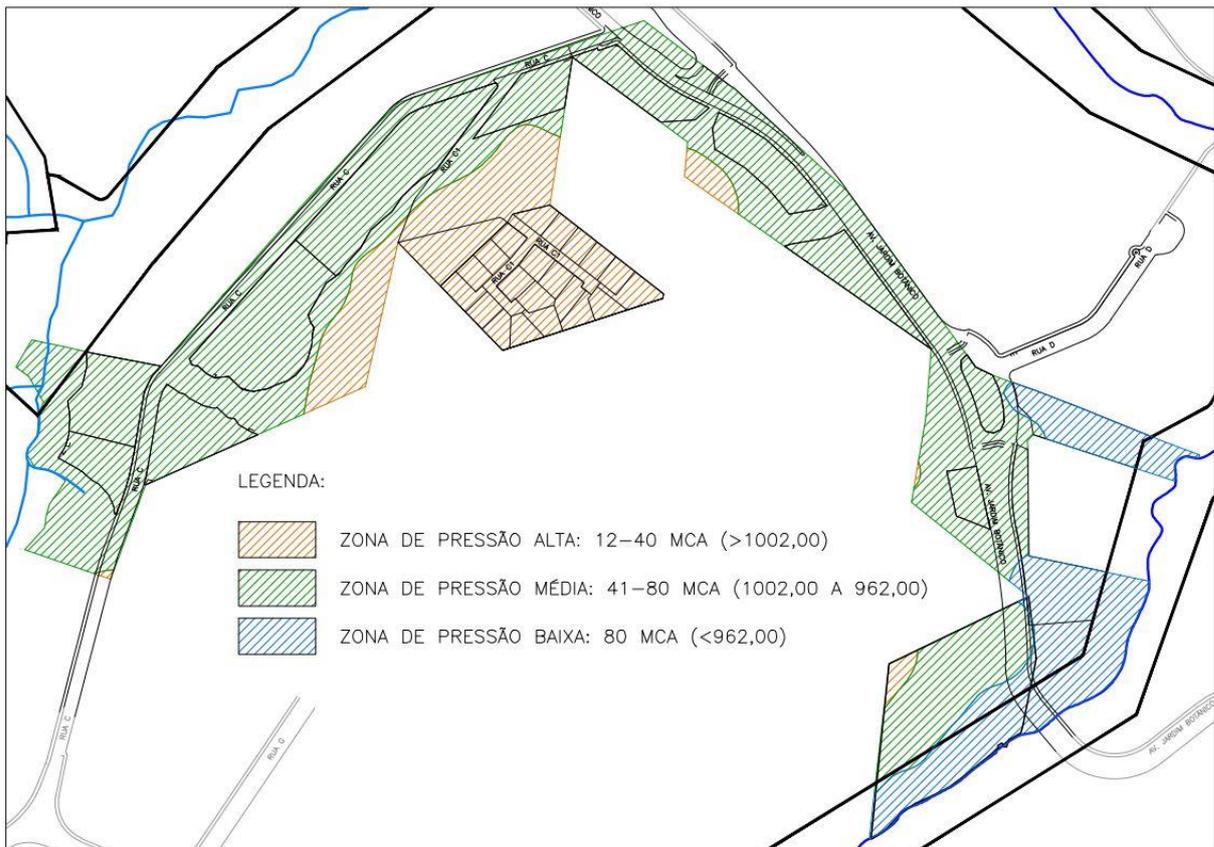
Zonas de pressão do Sistema de Abastecimento – Alternativa 02
